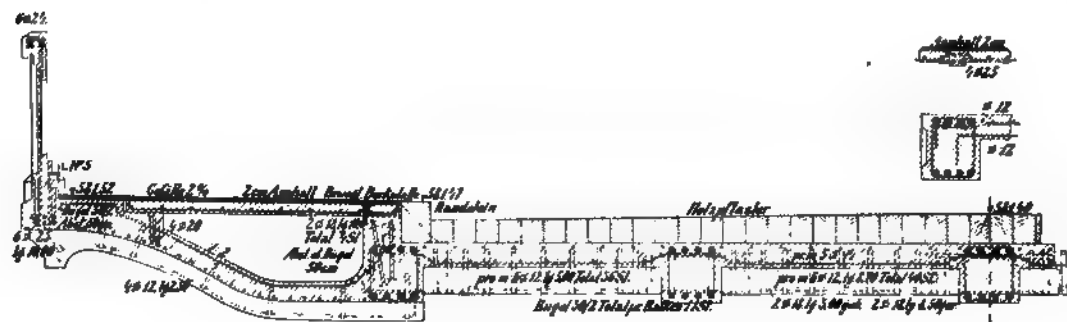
Konsolrippen mit Aussparungen für Leitungen.
